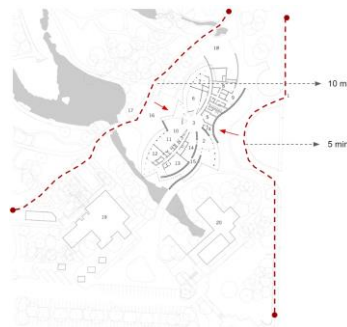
Lineamiento en función arquitectónica 1. Fuente: Archdaily
